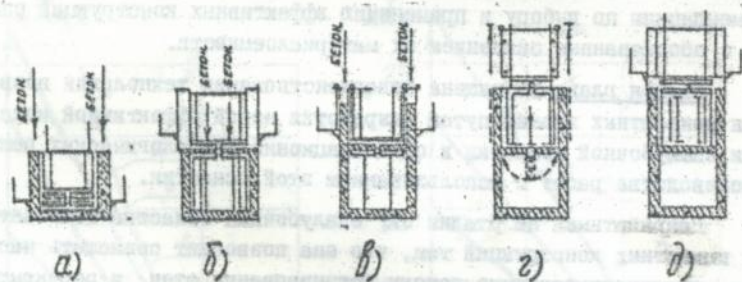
Последовательность бетонирования стен и междуэтажных перекрытий здания:
